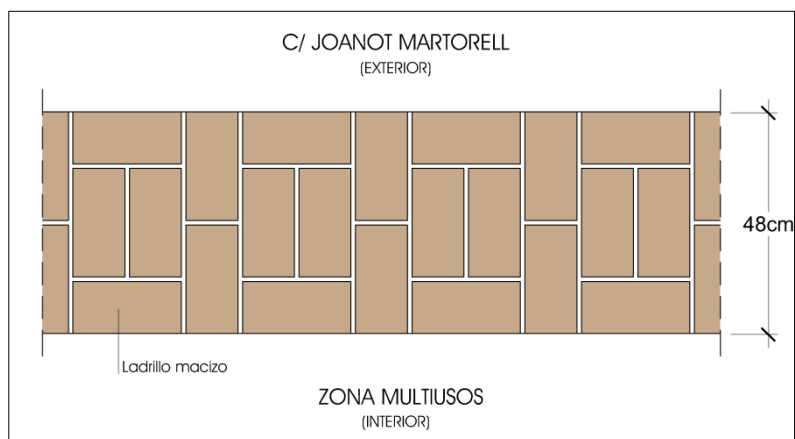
Detalle del cerramiento de la fachada con c/ Joanot Martorell
